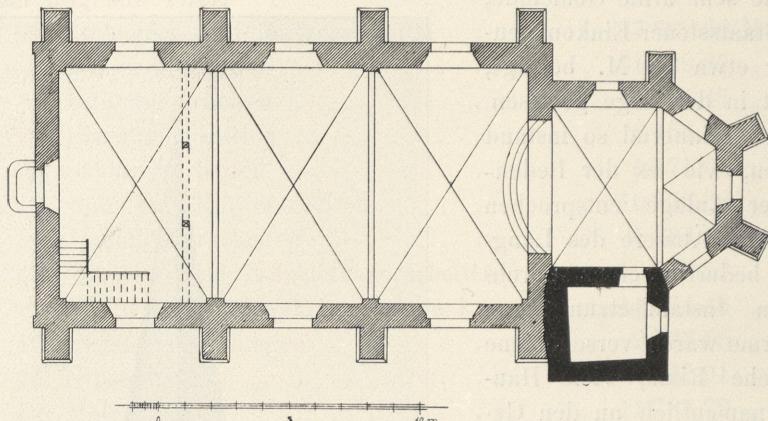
Schleidweiler. Kath. Pfarrkirche. Grundriss.
